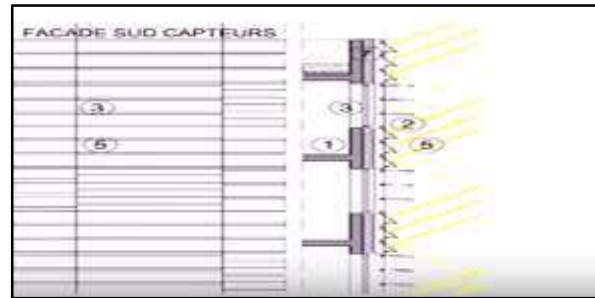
coupe schématique de la façade sud. Source : www.archdaily.com
